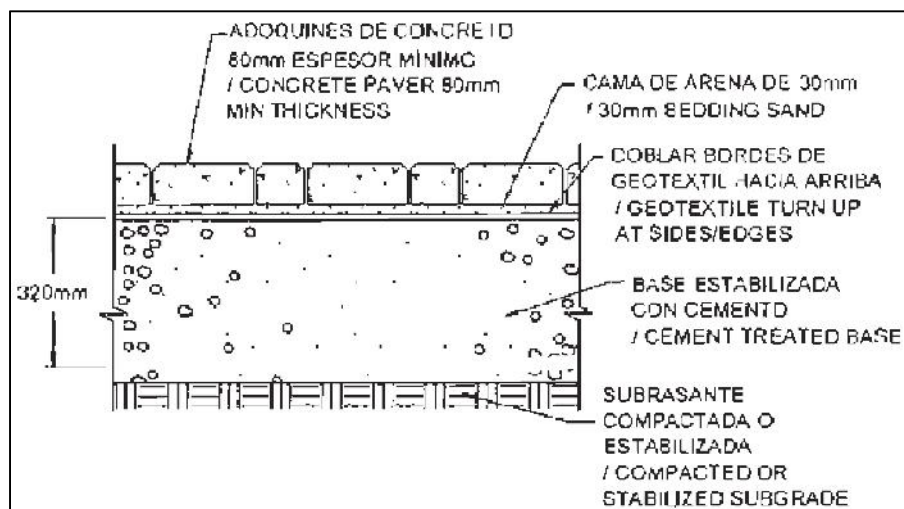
Estructura de pavimento diseñada y construida en la TCM
